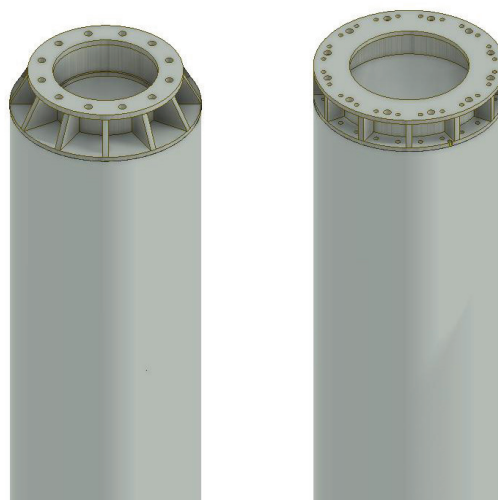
Фундаментные секции для установки промежуточных и анкерно-угловых железобетонных опор
